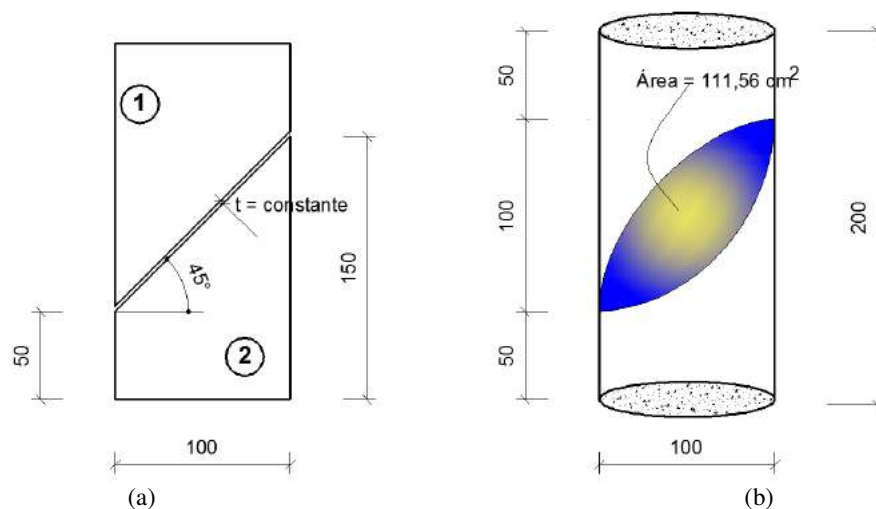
Determinação das tensões num plano a 45°: a) seção transversal do corpo de prova; b) dimensões do corpo de prova (medidas em mm).
